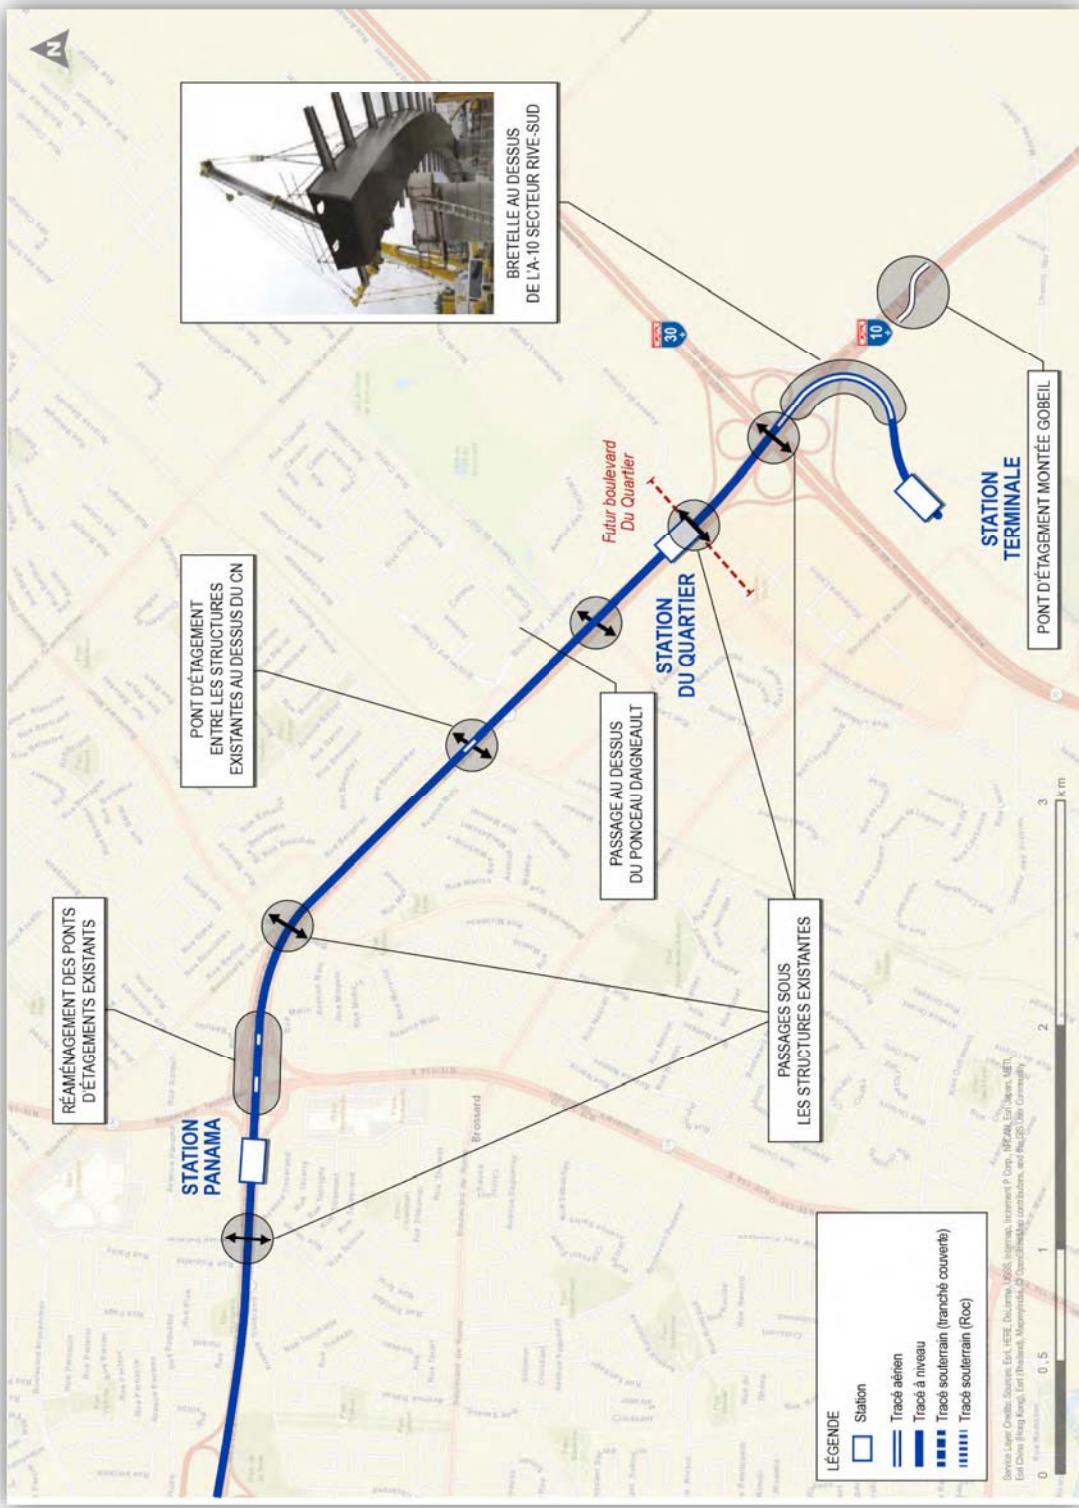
Ouvrages d'art – Secteur Rive-Sud
